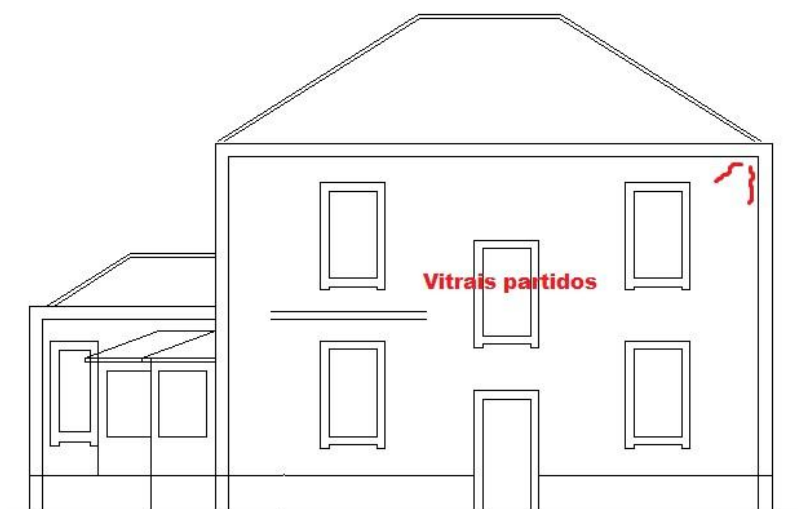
Fissuras na fachada lateral esquerda
